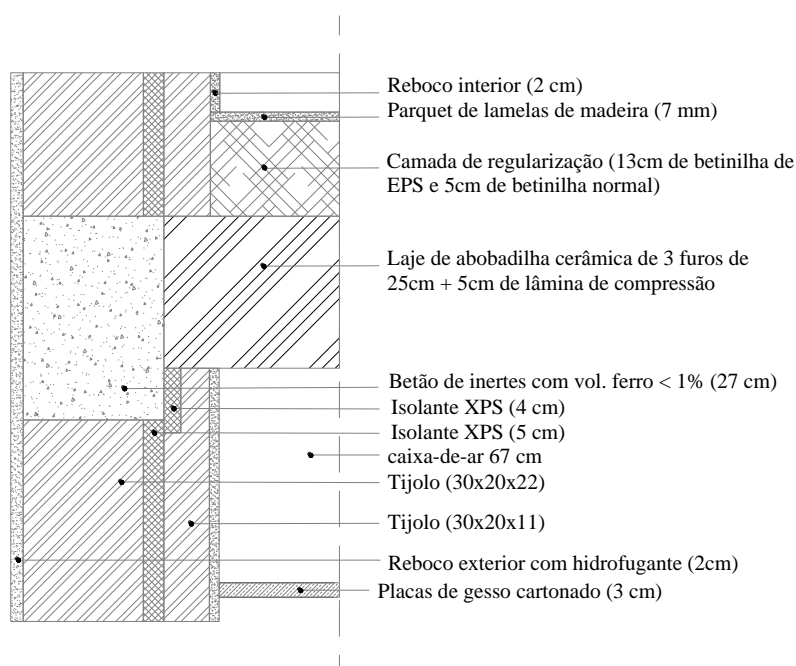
Laje de compartimentação interior entre pisos – Laje C.
